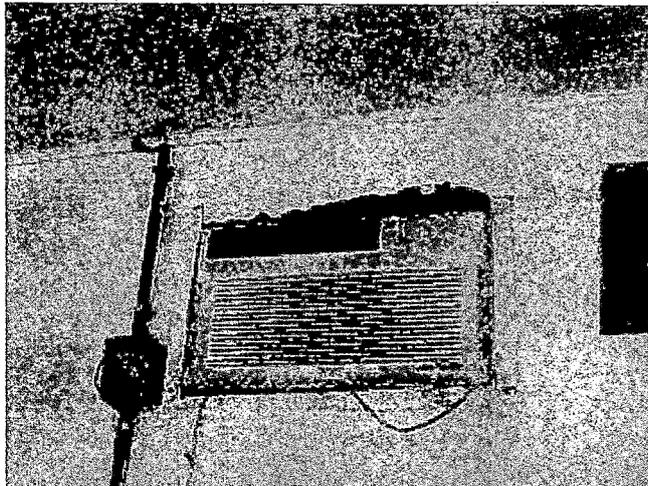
Falta de acabamento em alvenaria de caixa de ar condicionado
